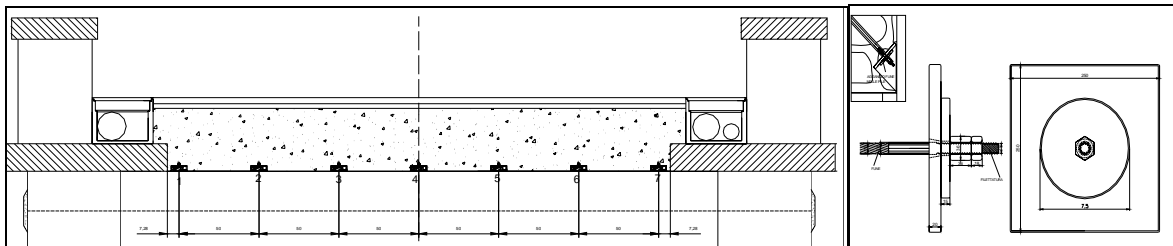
Sezione trasversale e particolare dell'ancoraggio del cavo
